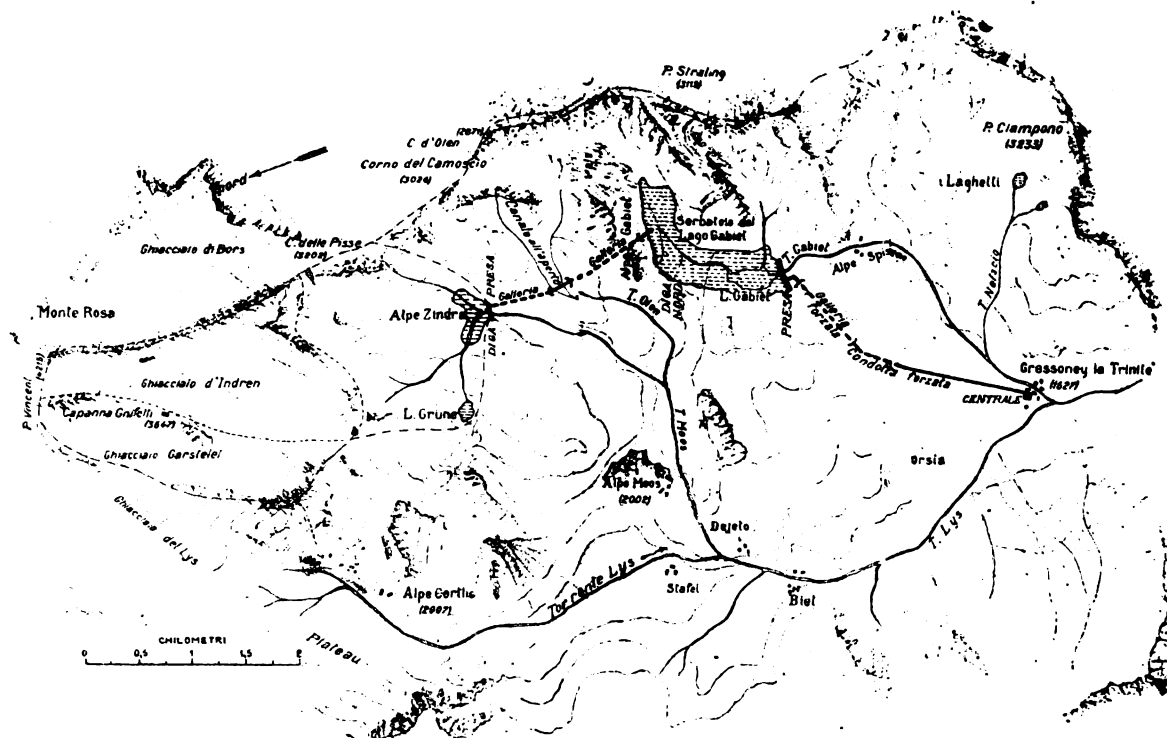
Planimetria generale dell'impianto Moos-Gabiet.
